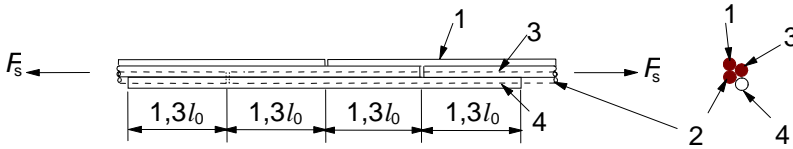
Zugbeanspruchter Übergreifungsstoß mit vierem Zulagestab
